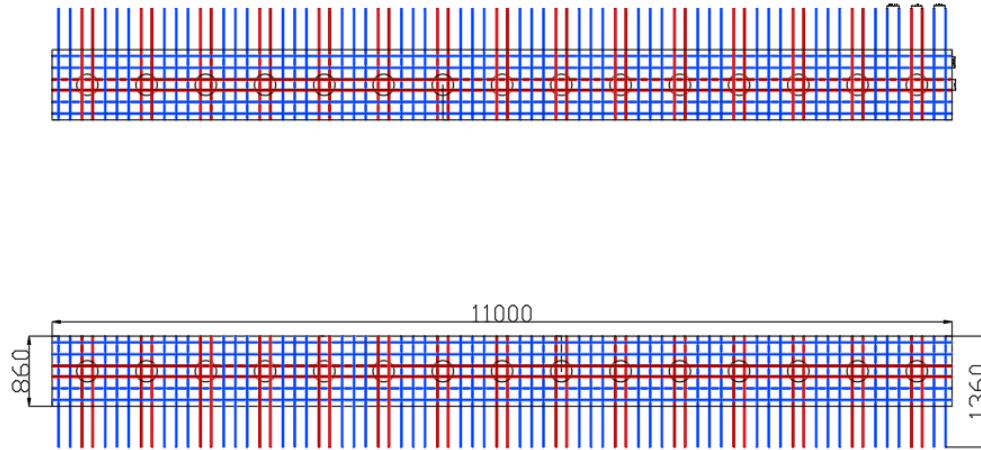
Armaduras completas de la Pila 4 con 15 micropilotes
